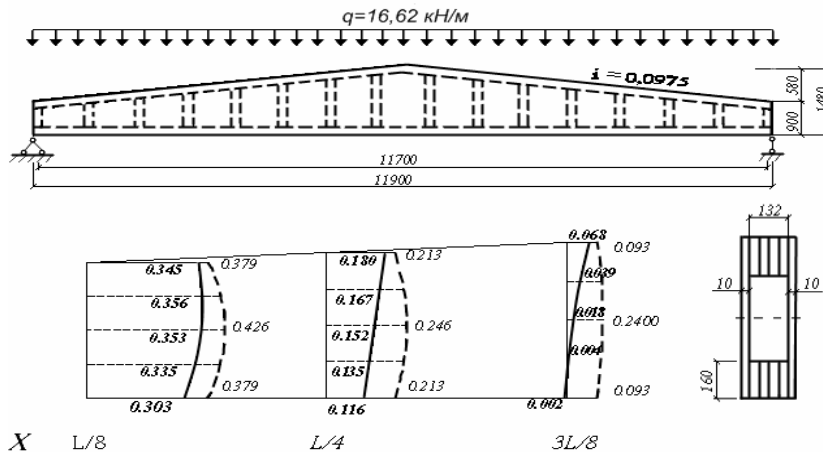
Конструкция балки и эпюры касательных напряжений по высоте стенки деревофанерной балки:
